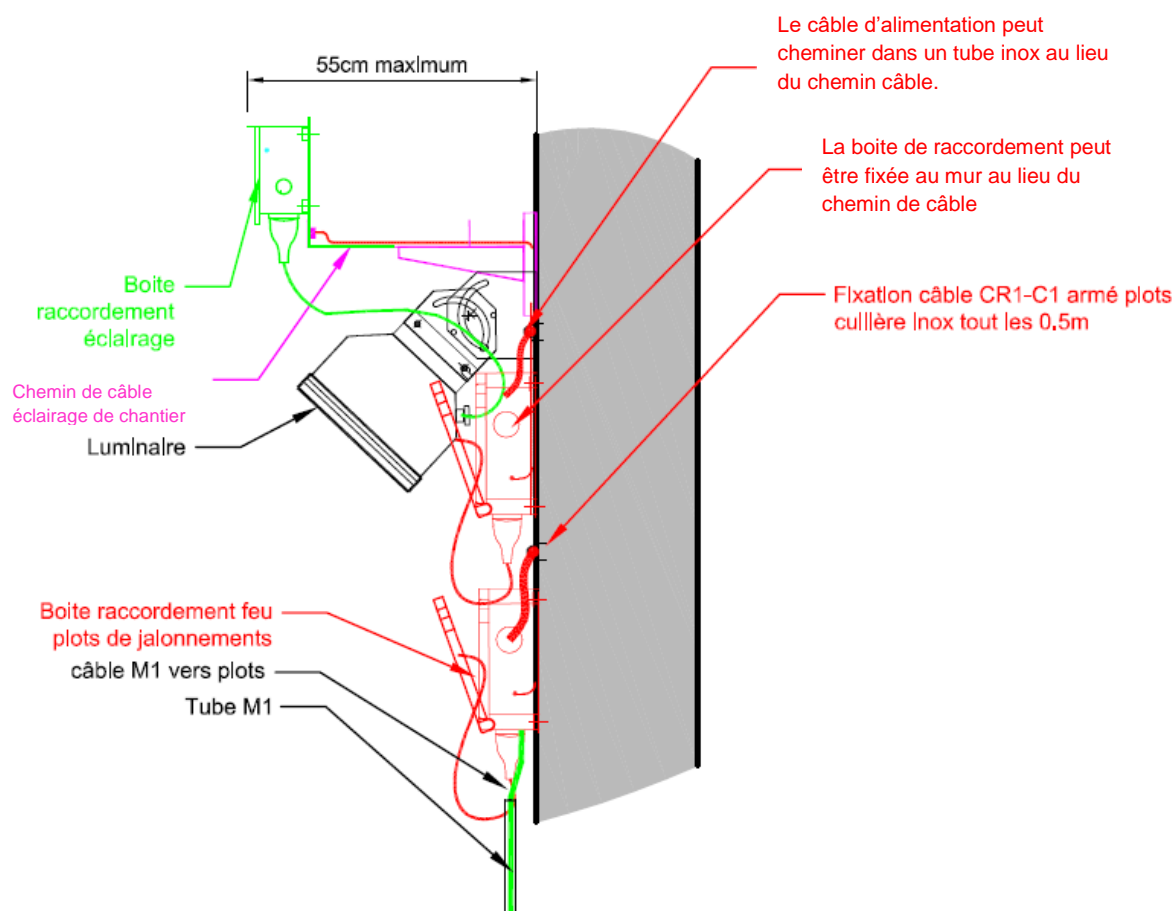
Implantation des luminaires de chantier sur les piédroits
